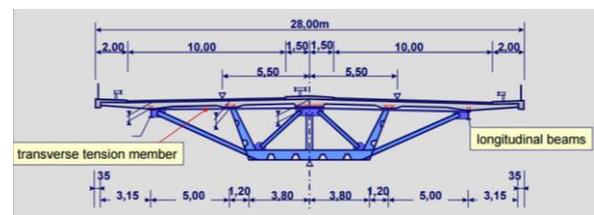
Сталежелезобетонная балка коробчатого сечения с увеличенными консолями железобетонной плиты [1]
